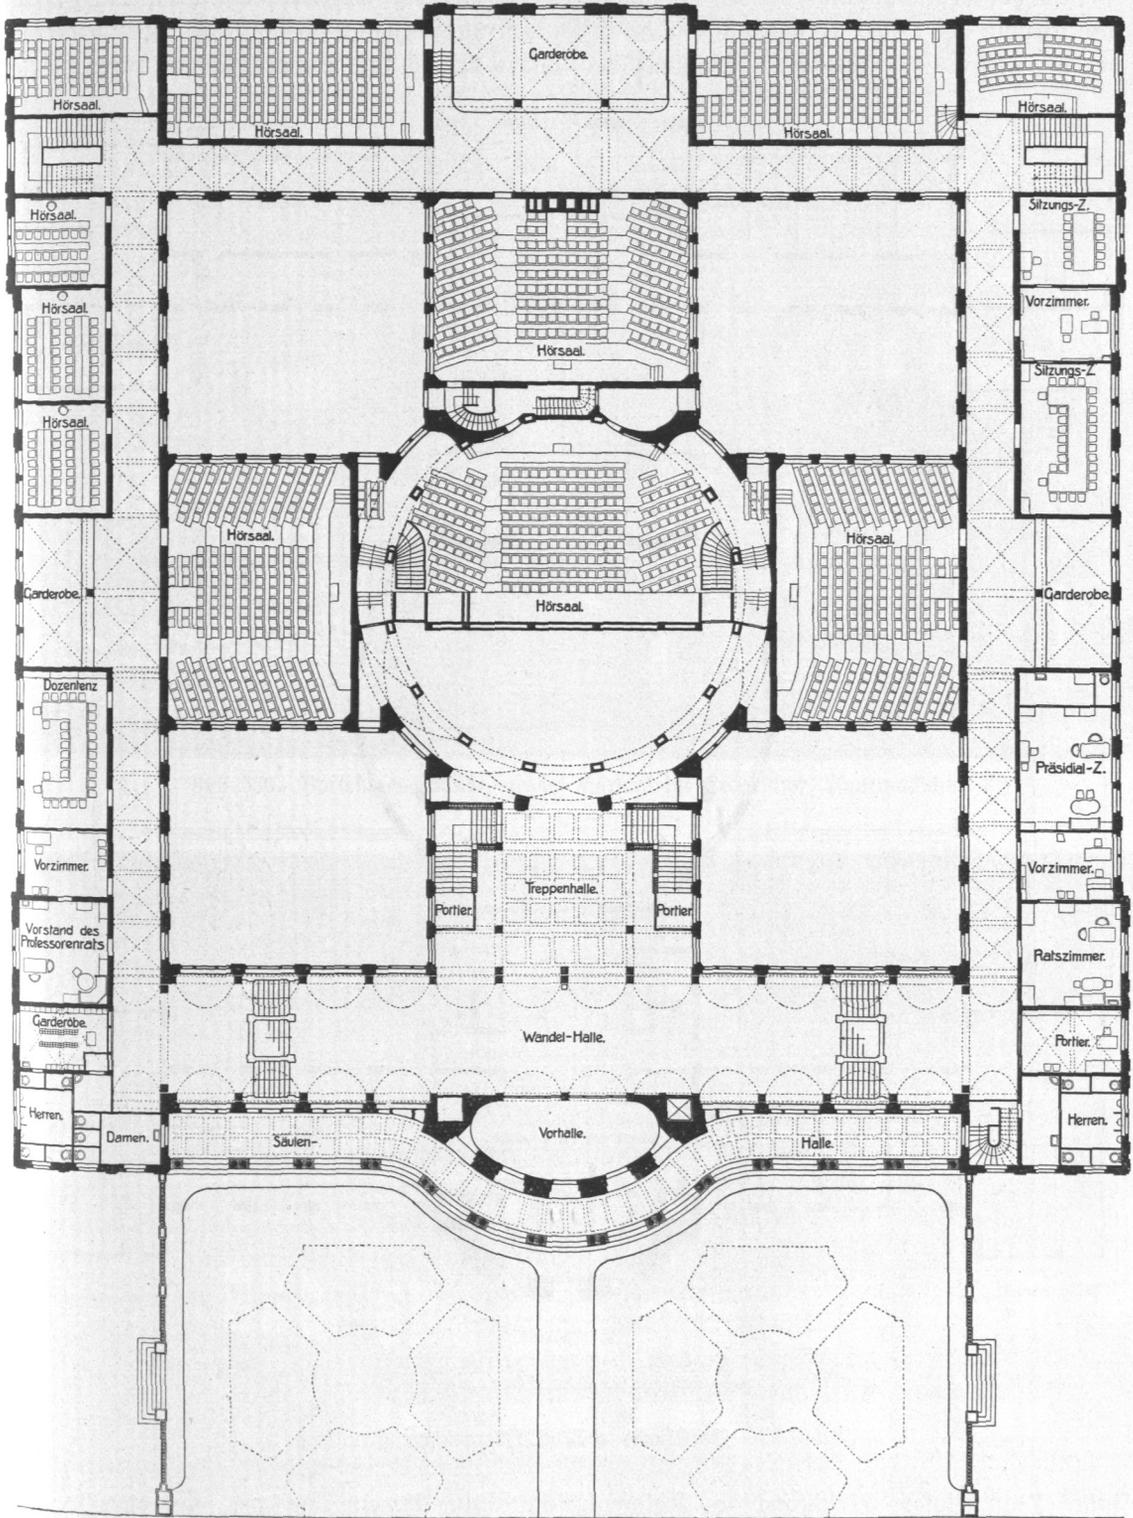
Vorlesungsgebäude, Erdgeschoß, Grundriß.
